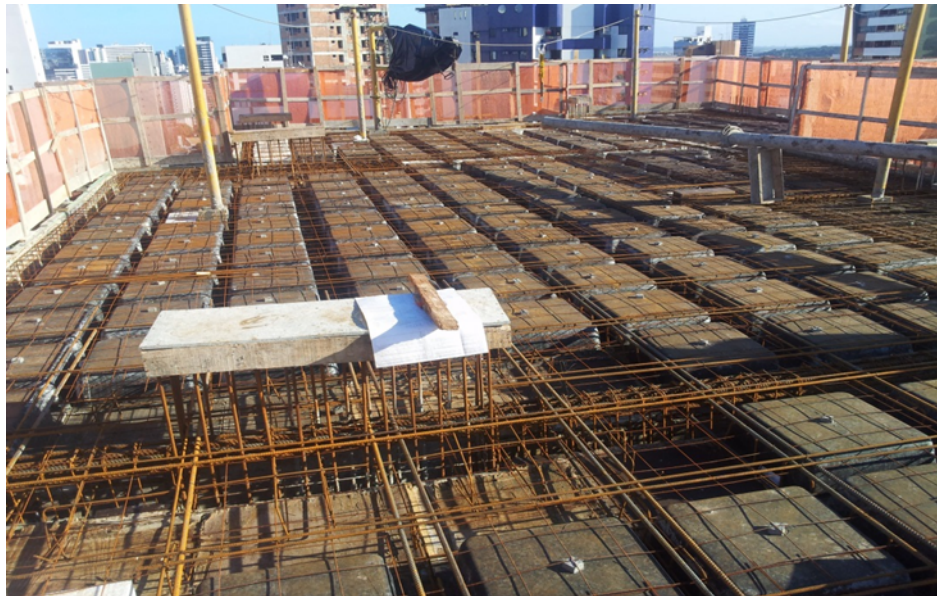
Vista Geral do Pavimento de Laje Nervurada Pré Concretagem.
